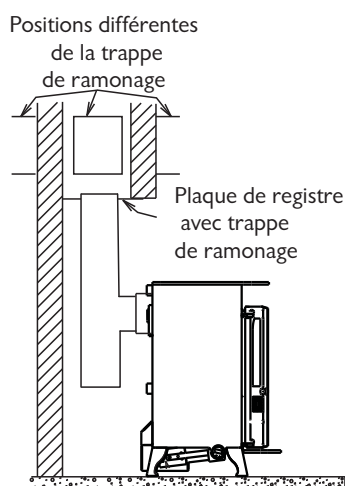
Plaque de registre horizontal avec raccord au conduit d'évacuation de fumée par le haut
